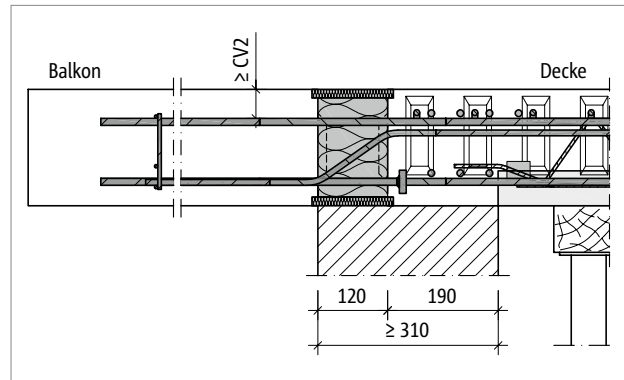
Schöck Isokorb® XT Typ CL: Halbfertigteilplatte mit Randunterstützung mit wärmedämmendem Mauerwerk (Schnitt XT Typ CL-R-CV2, Ansicht XT Typ CL-L-CV1)
